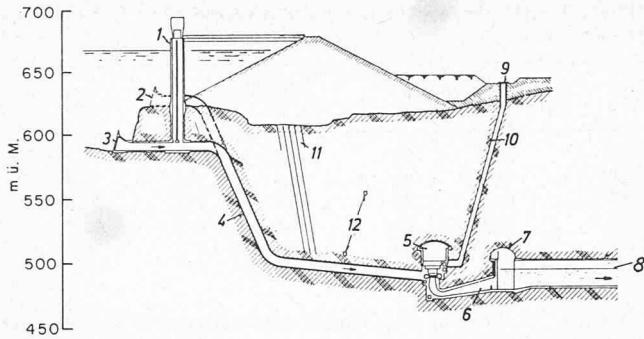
Längsschnitt der Kraftanlage G.M. Shrum. 1 Einlaufkontrolle, 2 und 3 Einlauf, 4 Druckrohre, 5 Maschinenhaus, 6 Auslass, 7 und 8 Ausgleichskammer und Ablasstunnel, 9 Umspannstation, 10 Kabelschacht, 11 Abschirmung, 12 Entwässerungstunnel
